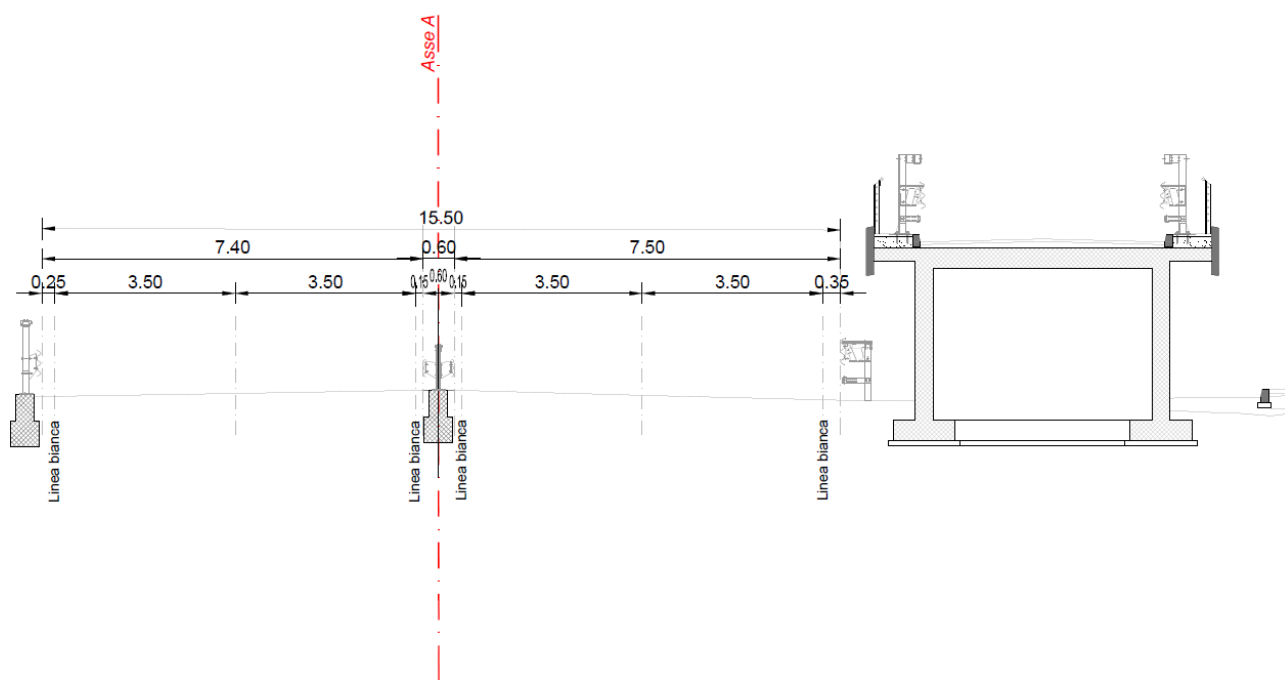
Sezione Stato di Fatto (sezione da rilievo).
